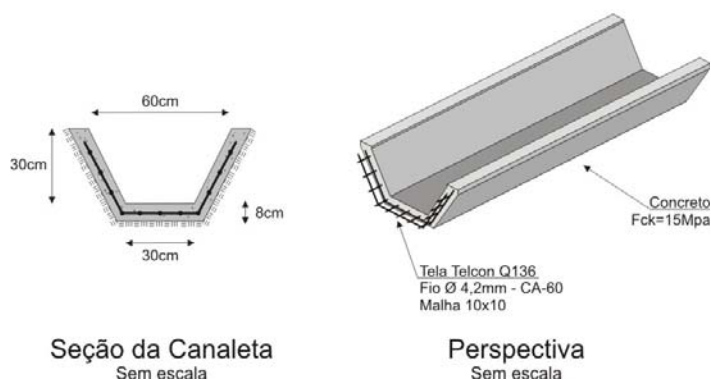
Modelo esquemático de canaletas de concreto
